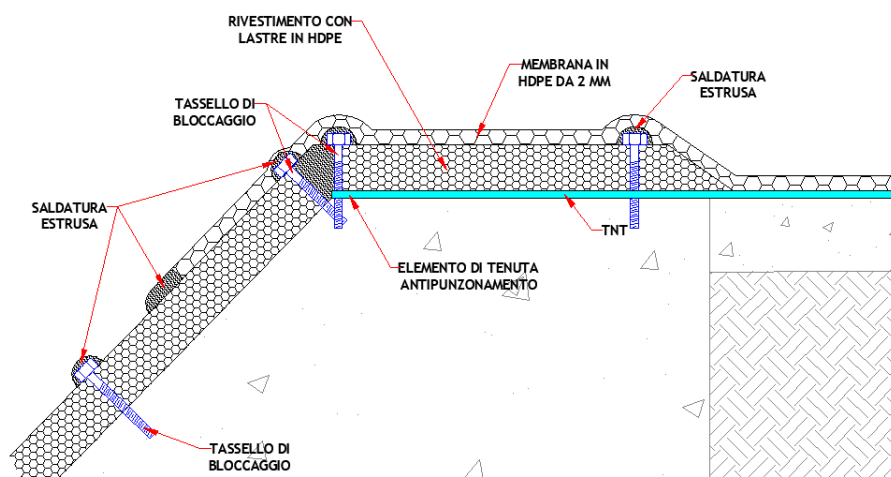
Particolare del collegamento lungo il bordo del pozzetto di scarico
